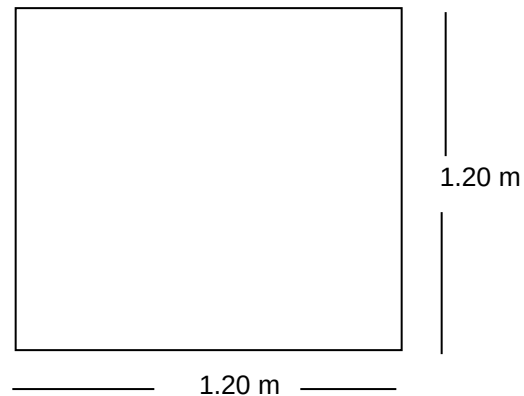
Vista en planta de la caja repartidora donde estará la toma.
